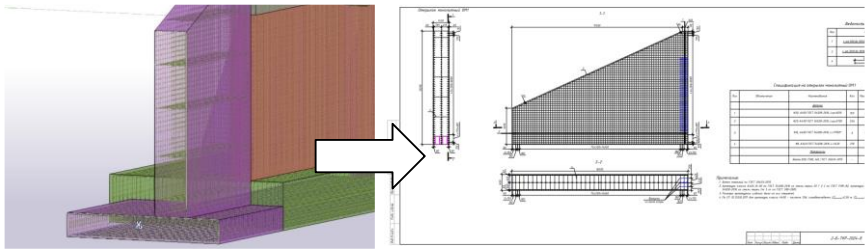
Формирование арматурных чертежей опоры-стенки из модели
